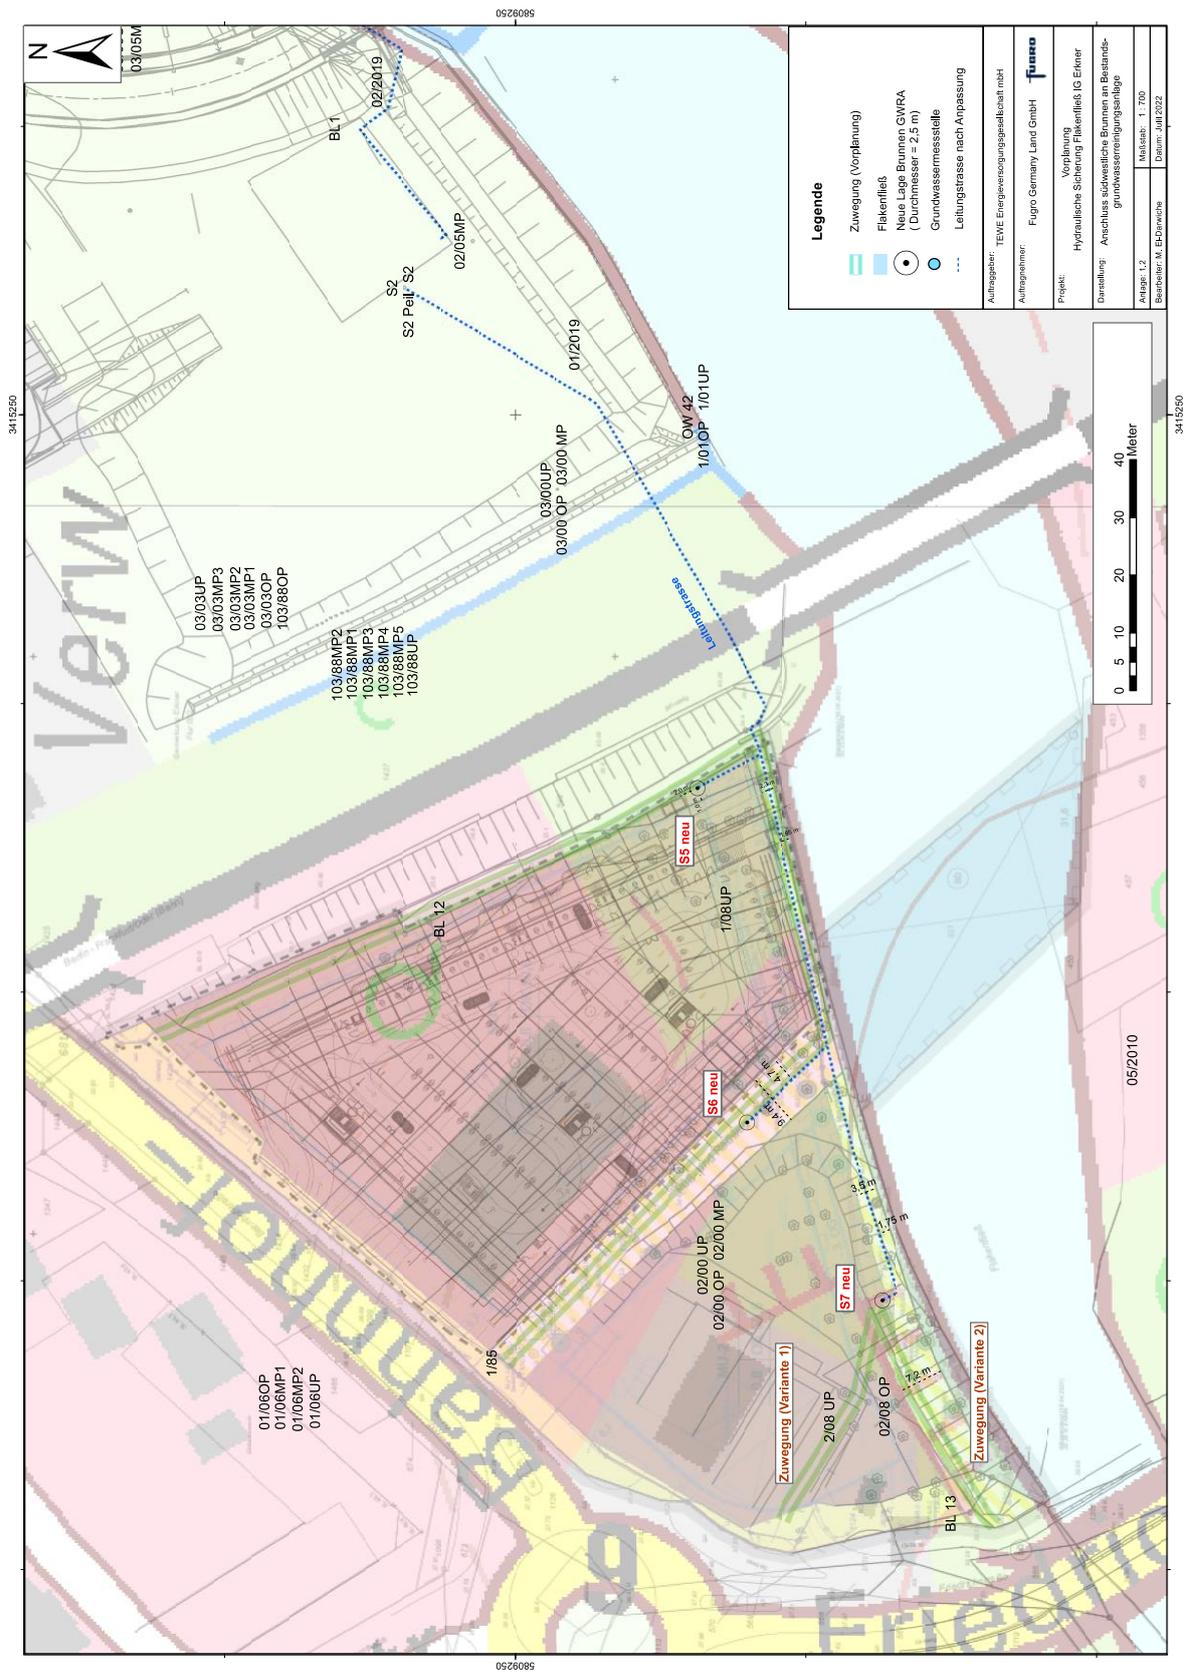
Anschluss südwestliche Brunnen Nr. S5, S6 und S7 an Bestandsgrundwasserreinigungsanlage
